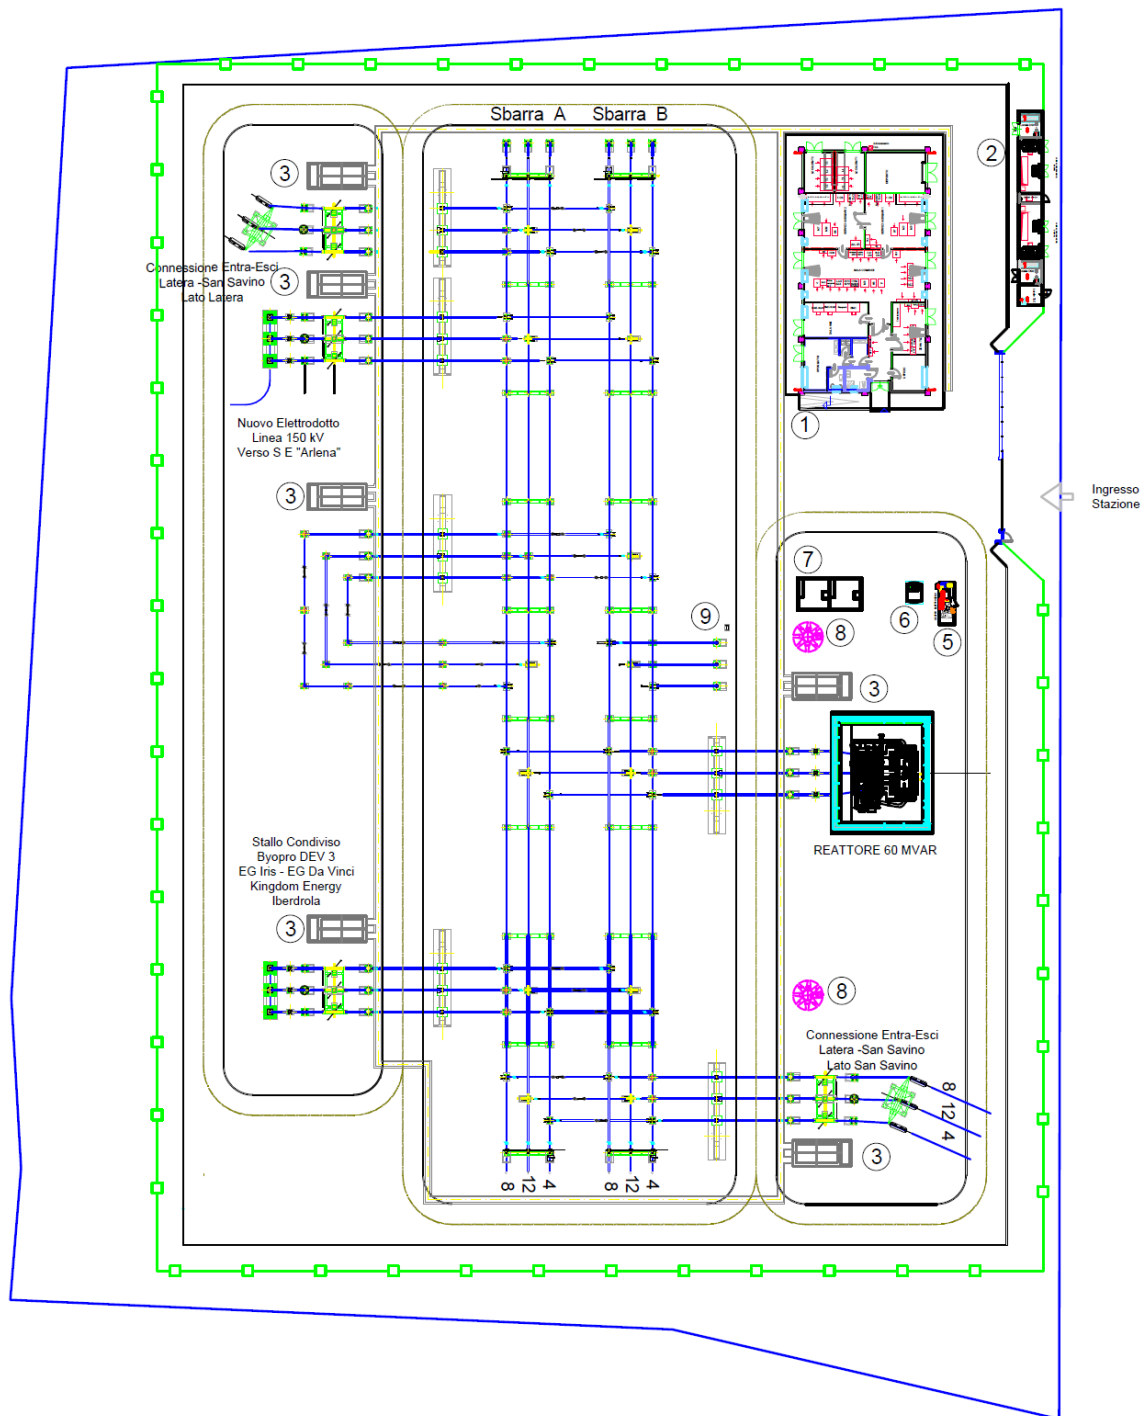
PLANIMETRIA ELETTROMECCANICA GENERALE
